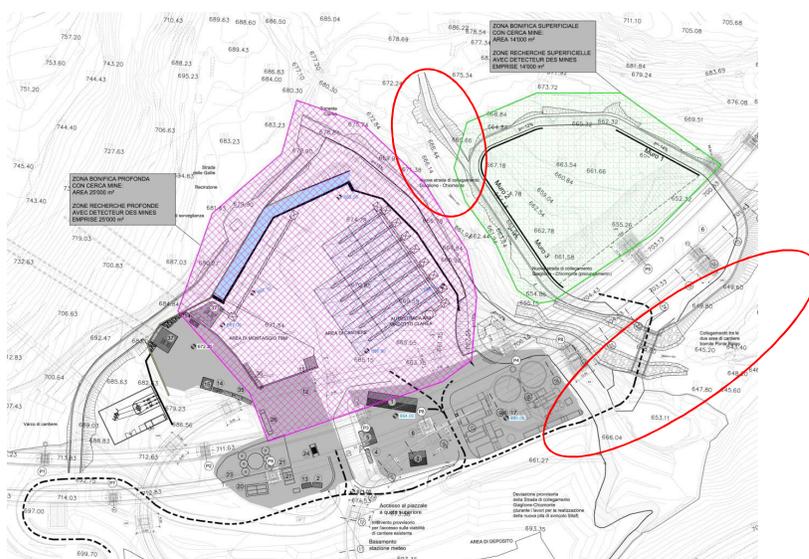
Estratto planimetria BOE – 1 di 2 – area di cantiere della Maddalena (dall'elaborato grafico n. PRV_C3A_7582)
